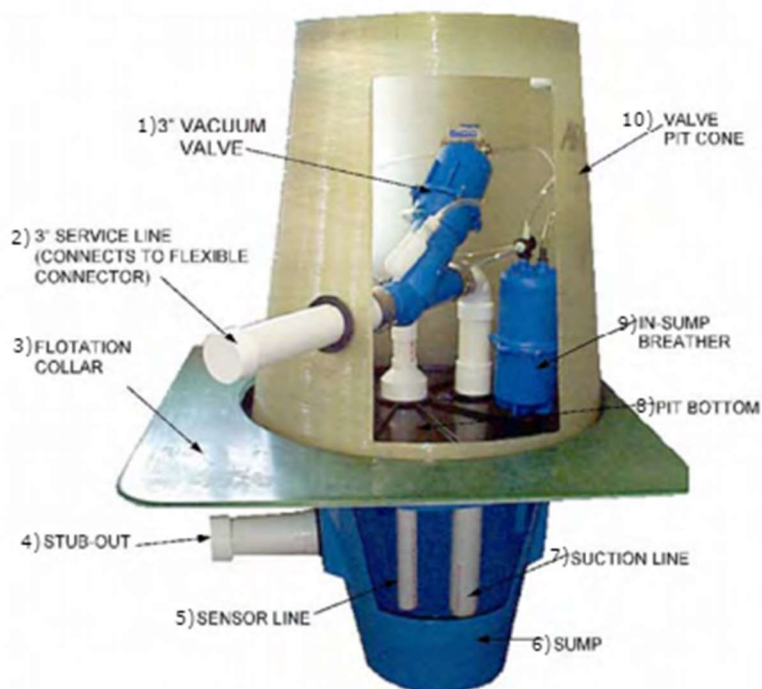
Sběrná šachta se sacím ventilem zavzdušňovaným potrubím, zdroj: ČSN EN 1091
